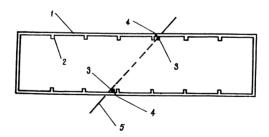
Слема разрезки на отсеки каменного бескаркасного здания с легким покрытием, расположенного под значительным углом к простиранию пластов:
